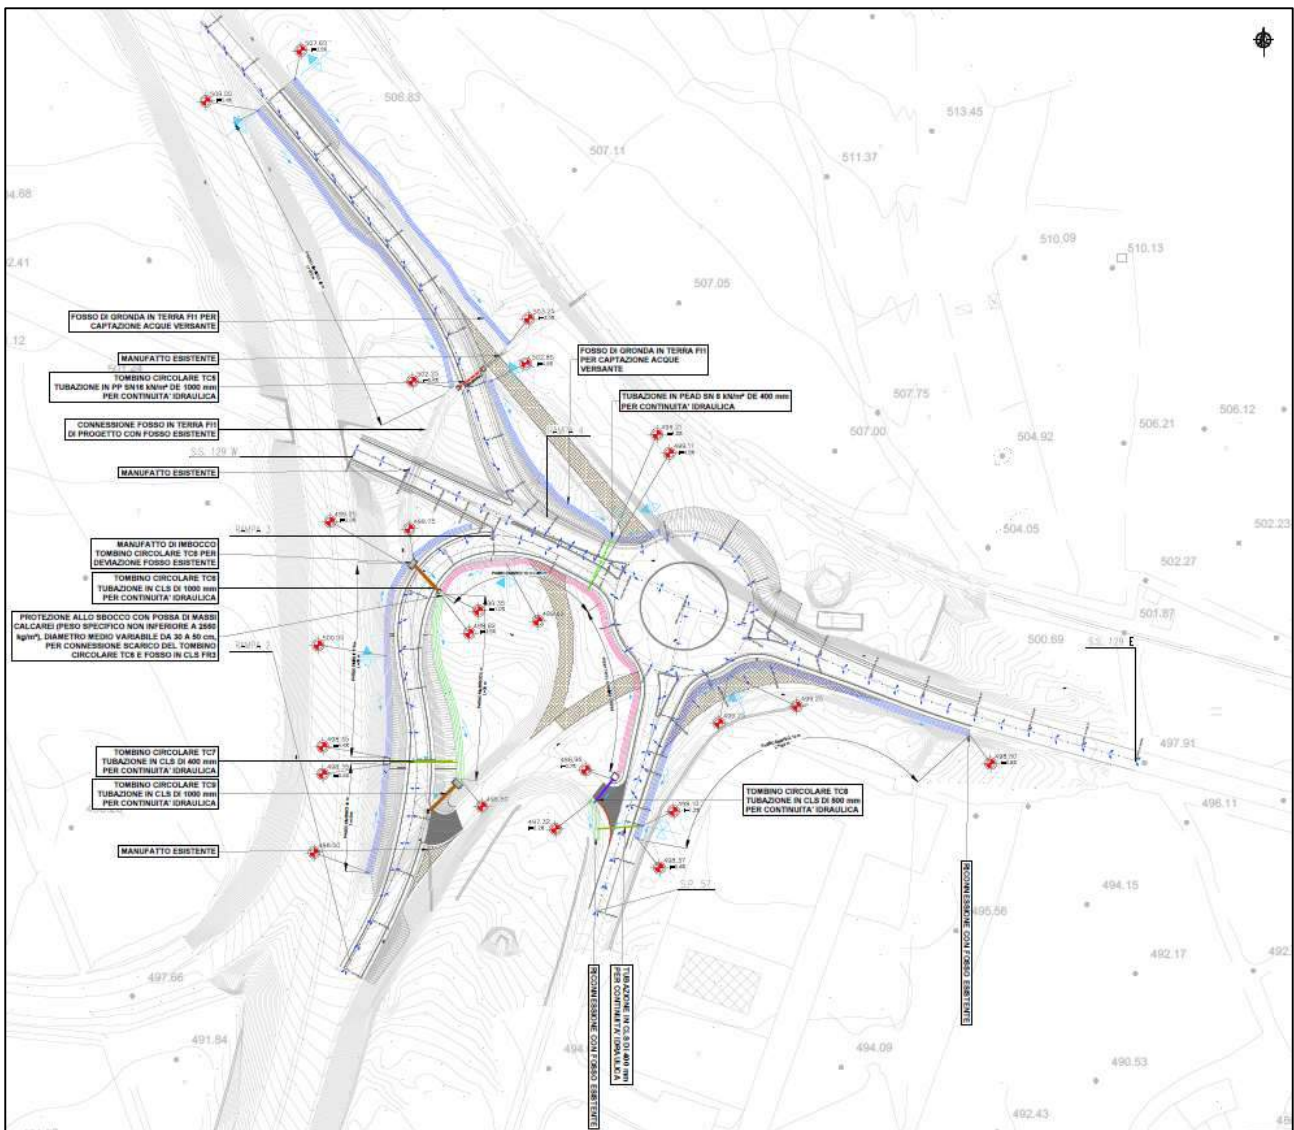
Stralcio planimetrico intervento V09-Svincolo di Macomer al km 142+500
